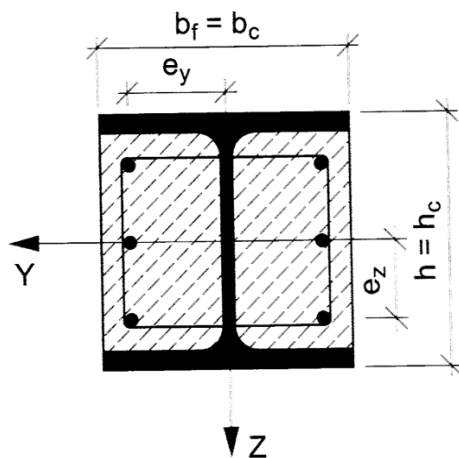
Конструктивное решение сталежелезобетонного сечения колонны
